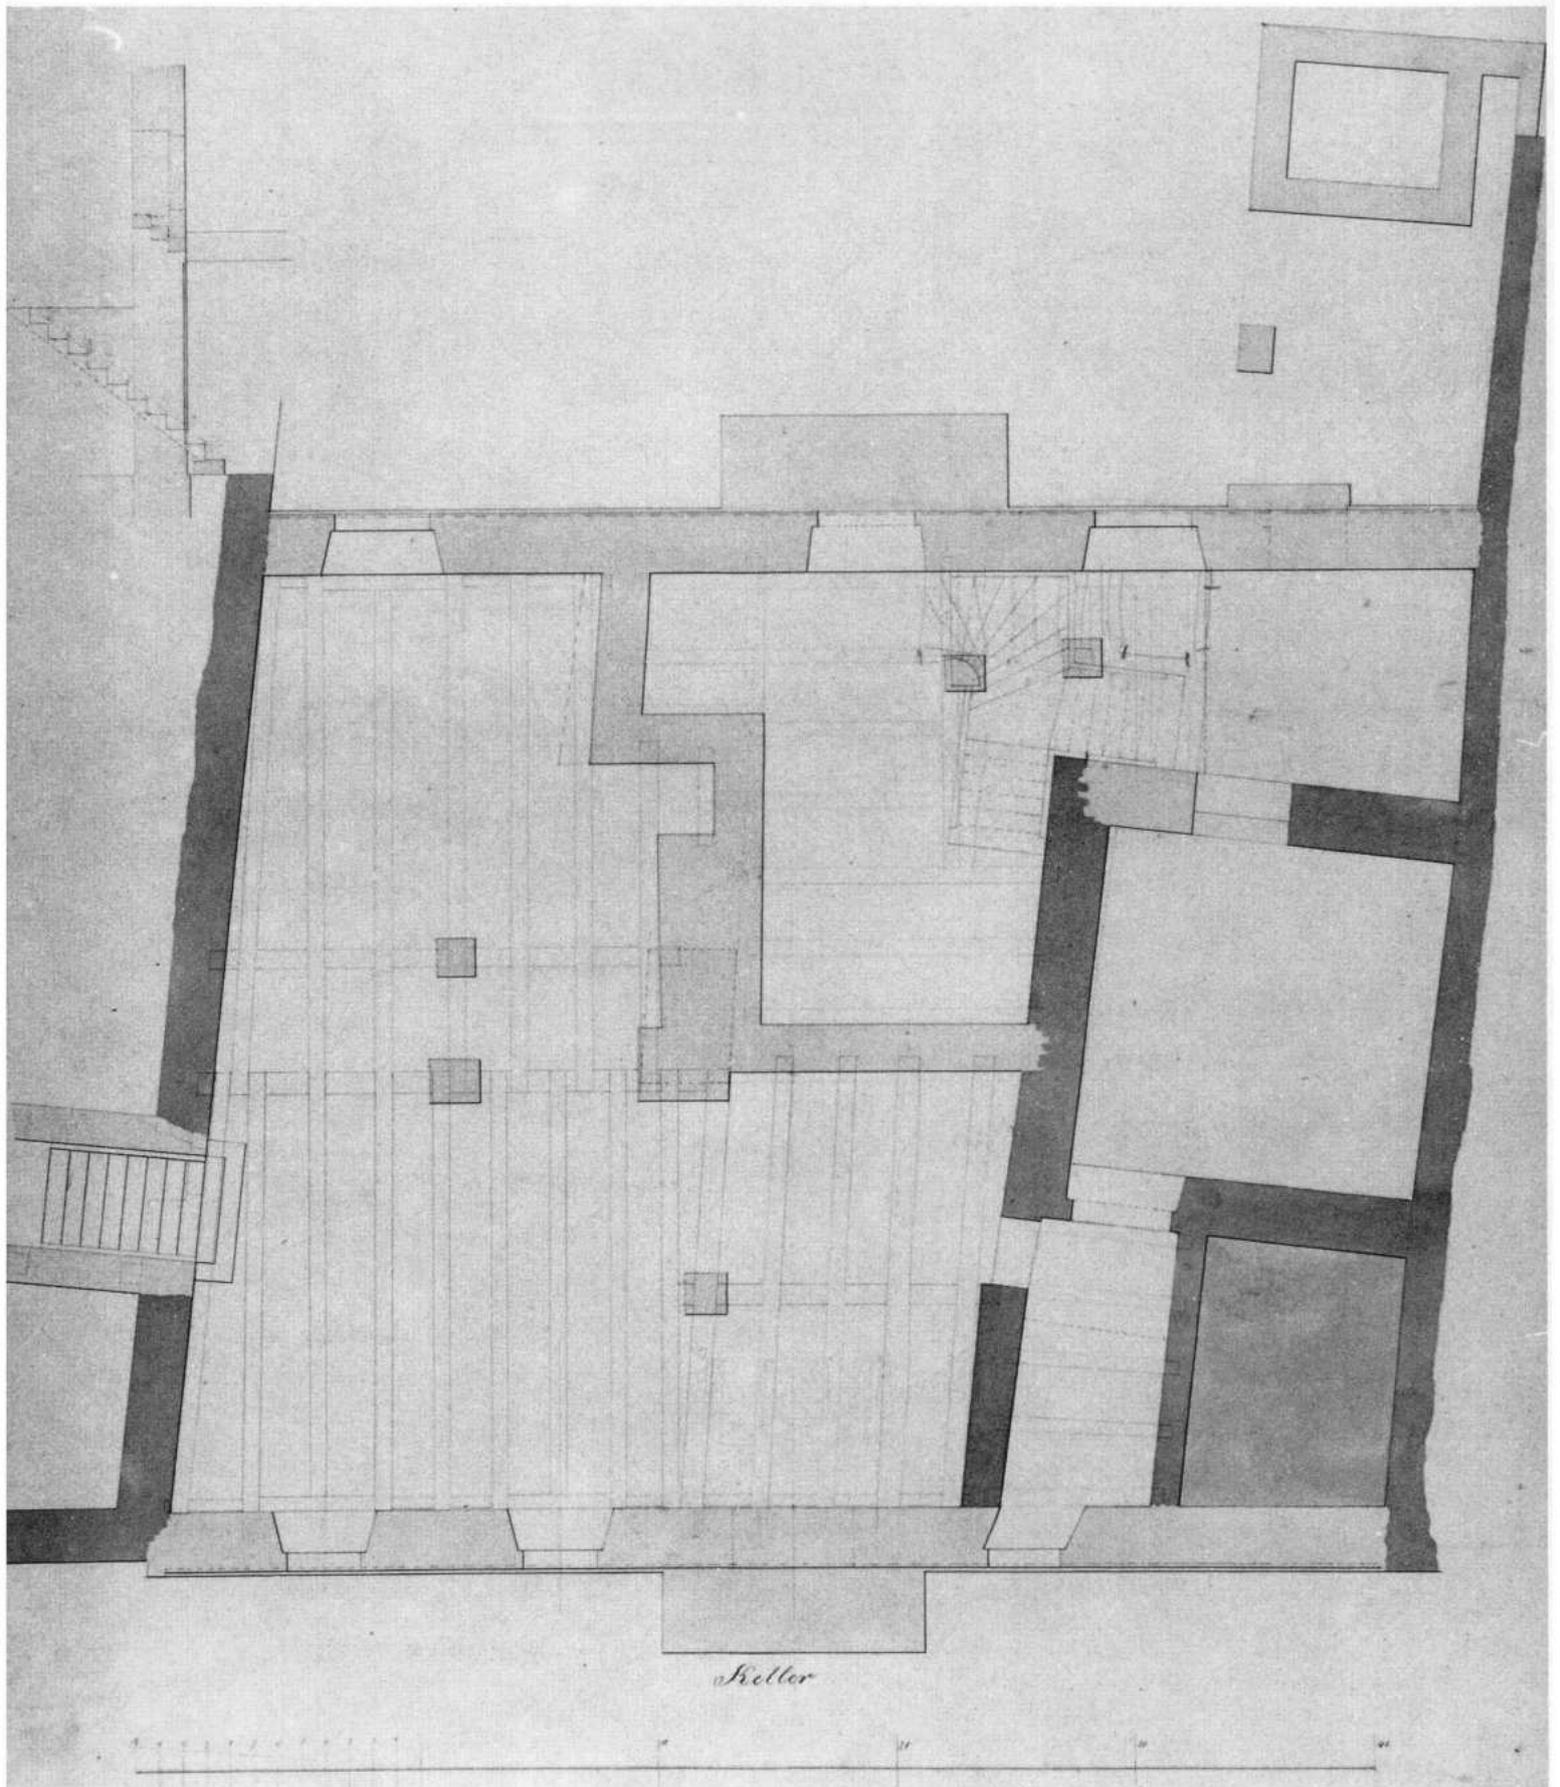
Grundriss des Kellers von Haus Rittergasse Nr. 31 mit dem noch bestehenden Keller eines mutmasslichen Kernbaues. Projektplan von der Hand J.J. Stehlins d.Ä., 1832. Privatbesitz. – Die anlässlich des Neubaus von 1832 übernommenen Mauerteile der Vorgängerbauten auf der Parzelle sowie die Brandmauern der angrenzenden Liegenschaften sind dunkel gerastert. – Massstab 1:100.
